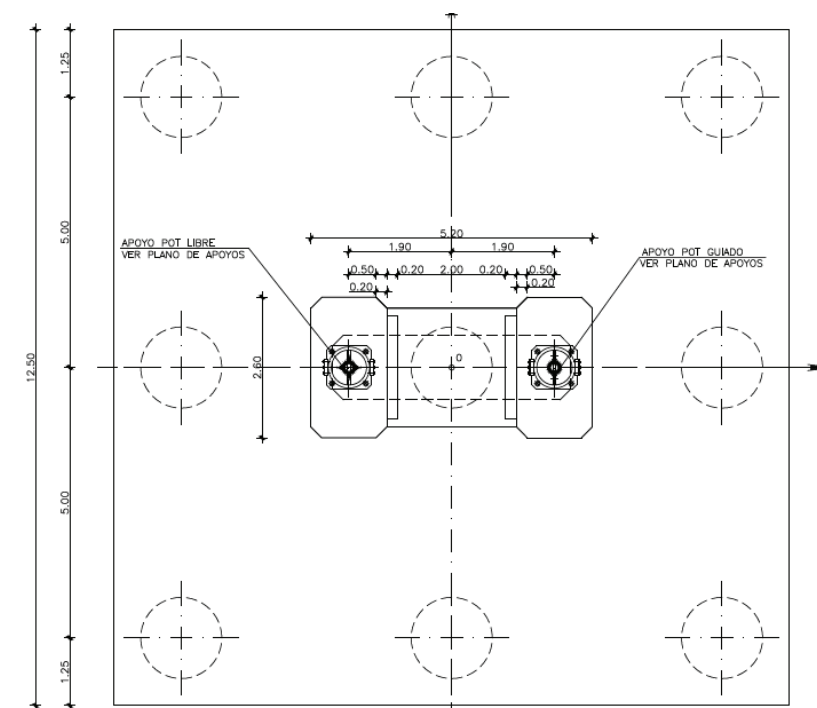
Distribución pilotes pila P-6 viaducto LAV
